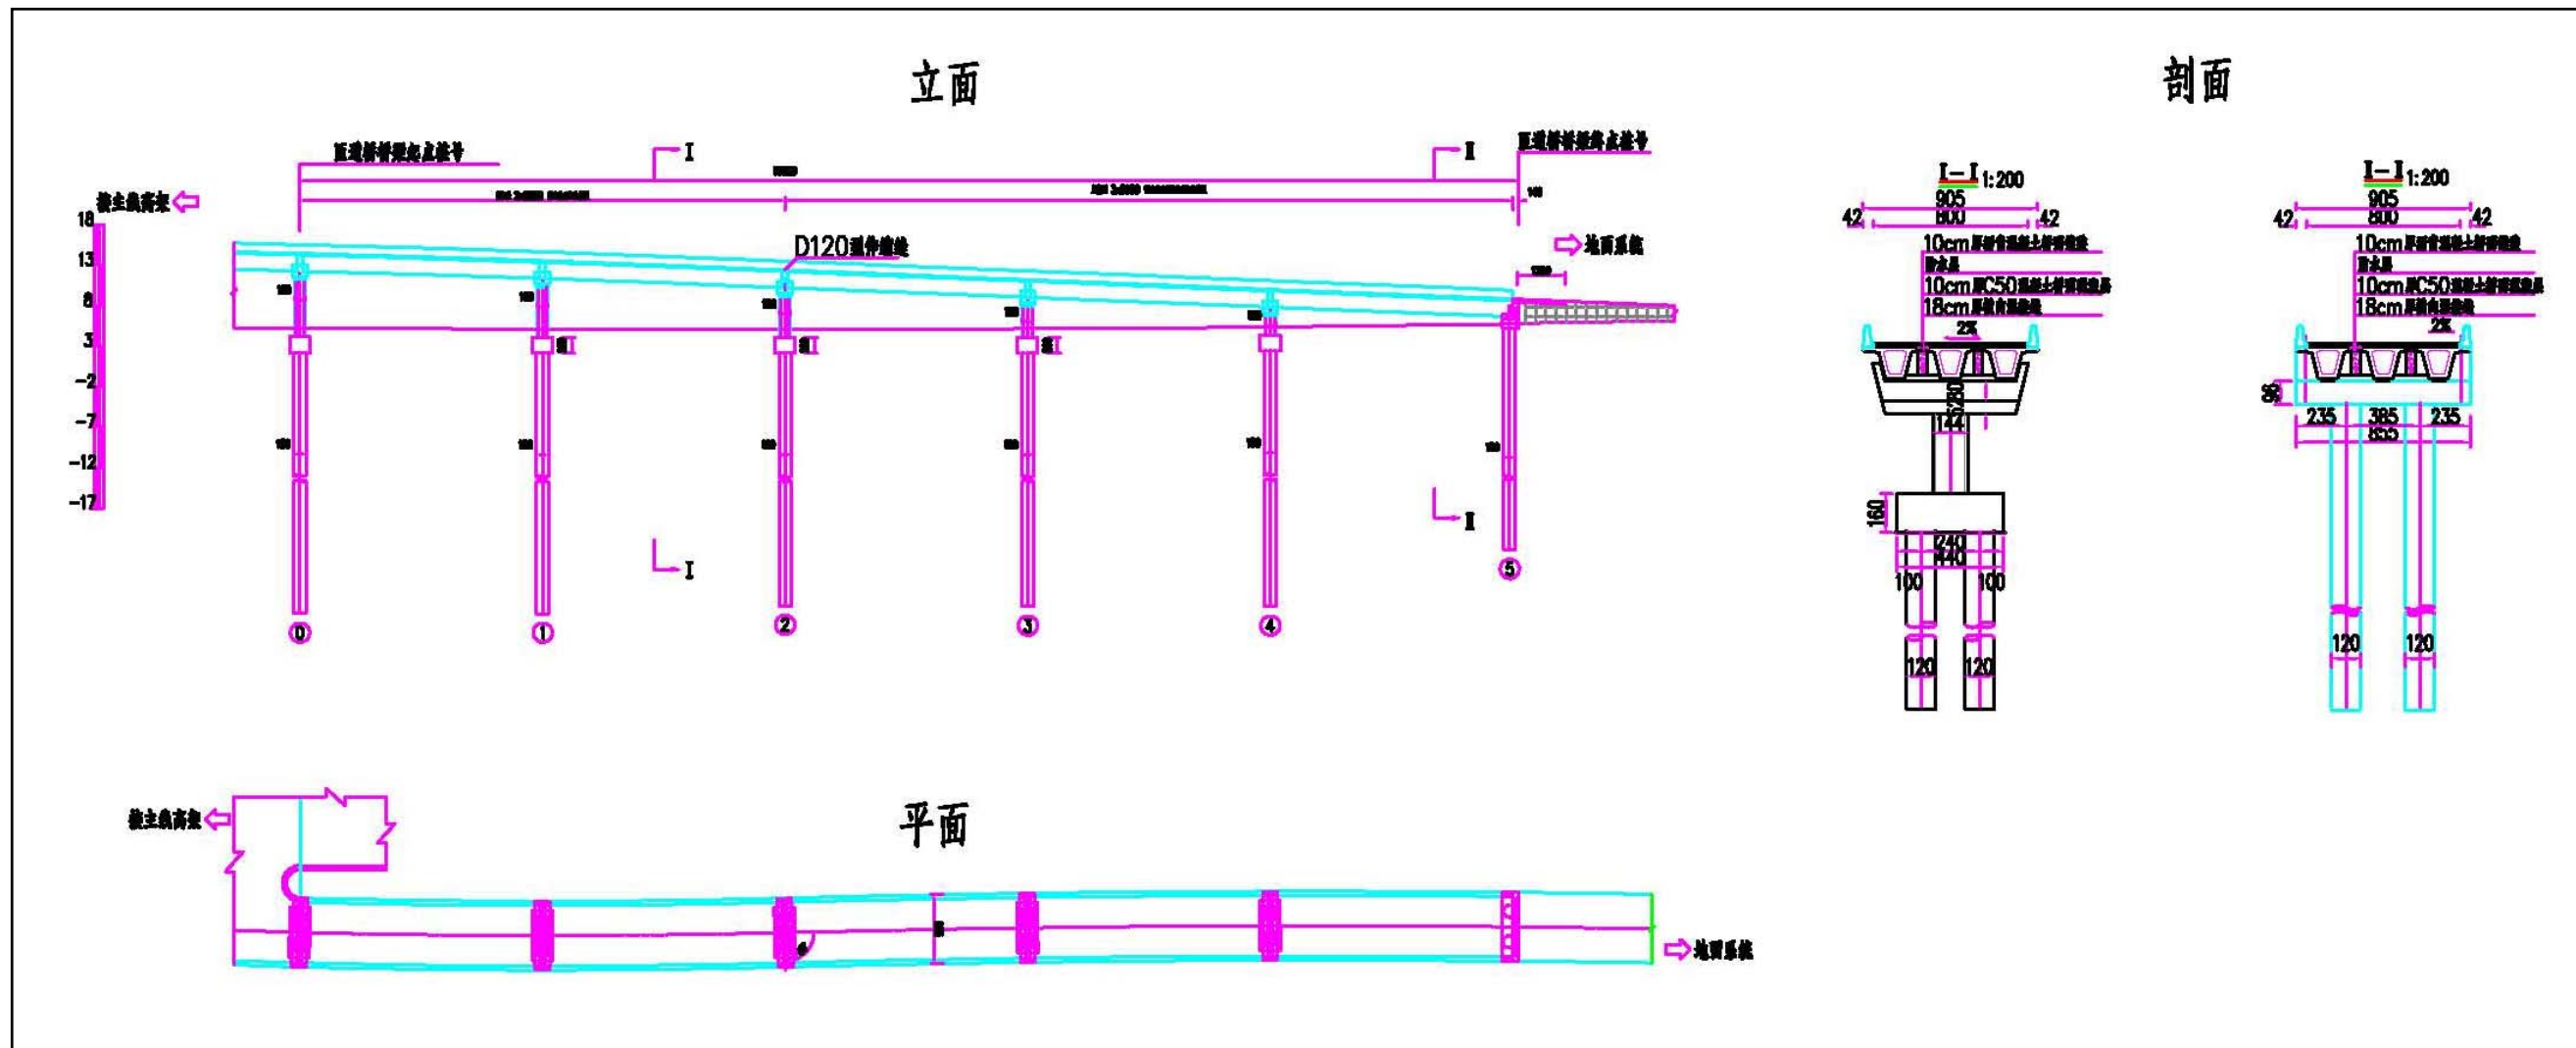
匝道桥桥型平面布置图 (含立面、横断剖面)
